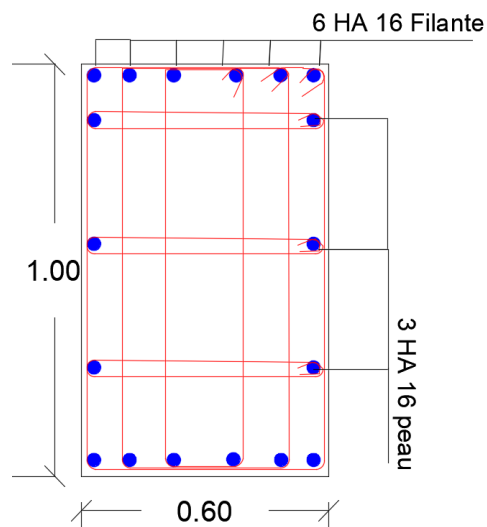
Schéma de ferrailage des nervures (sur appuis et en travée)
